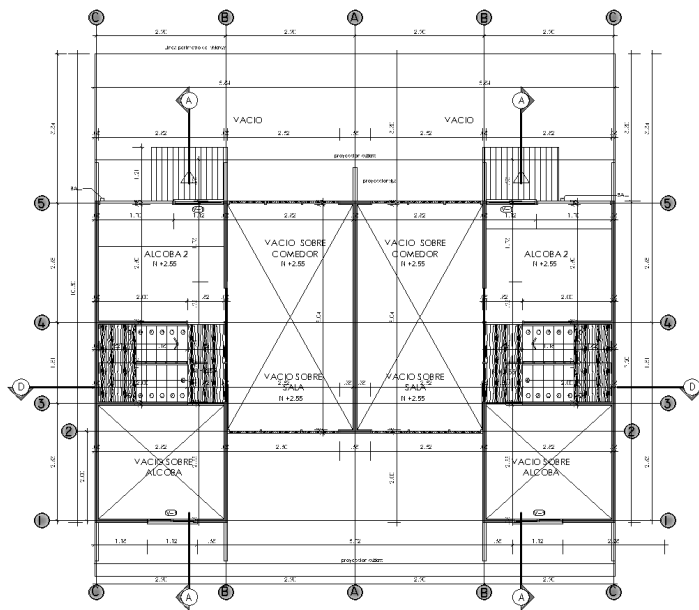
planta arquitectónica piso 2 (muros prefabricados-SC).
